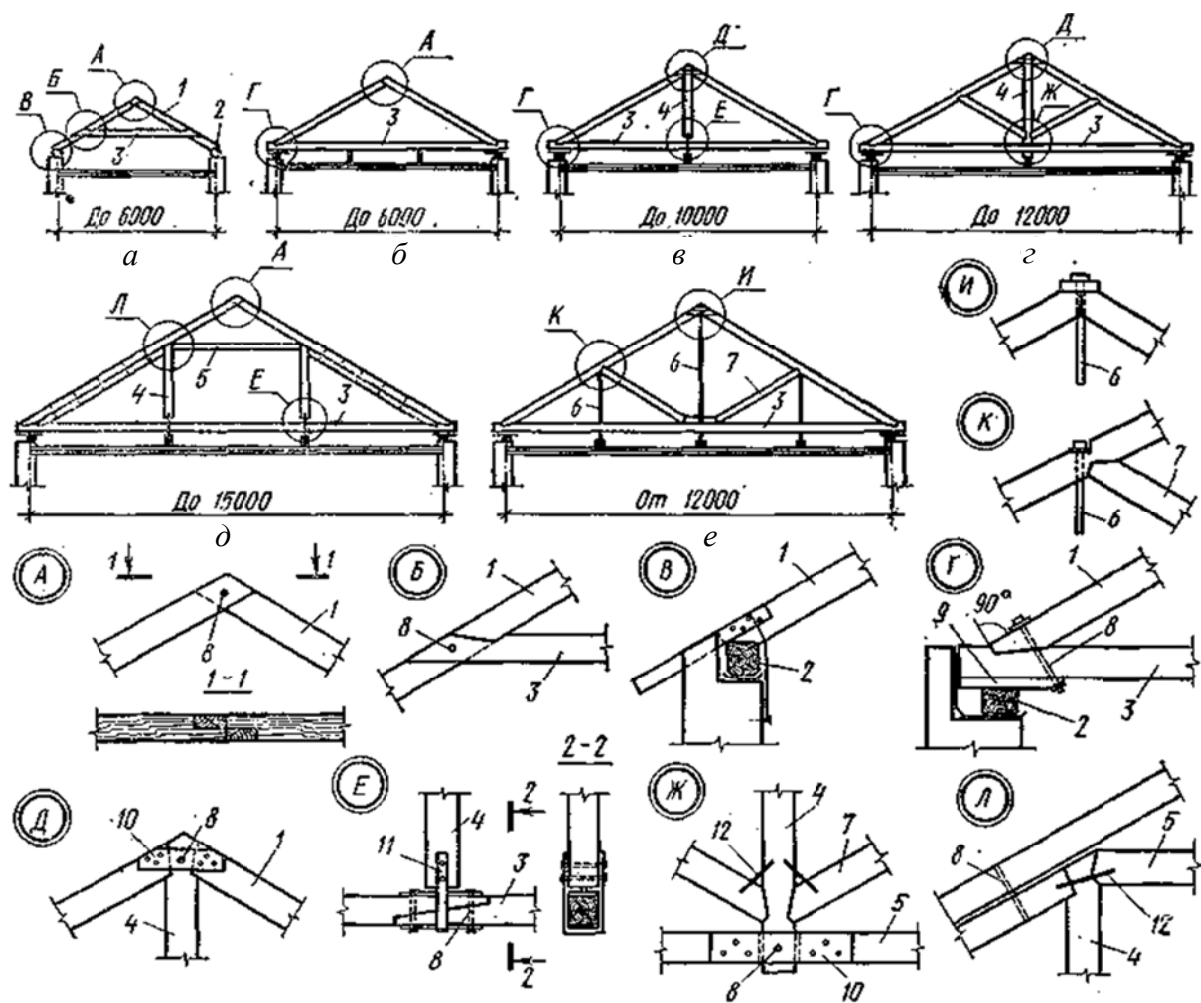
Деревянные висячие стропила (стропильные фермы):
